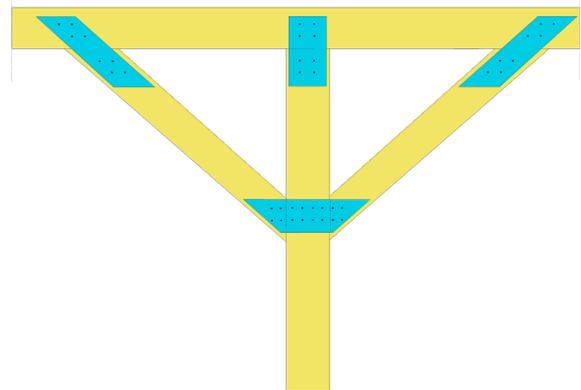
Anschlüsse mit außenliegendem Stahlblech
